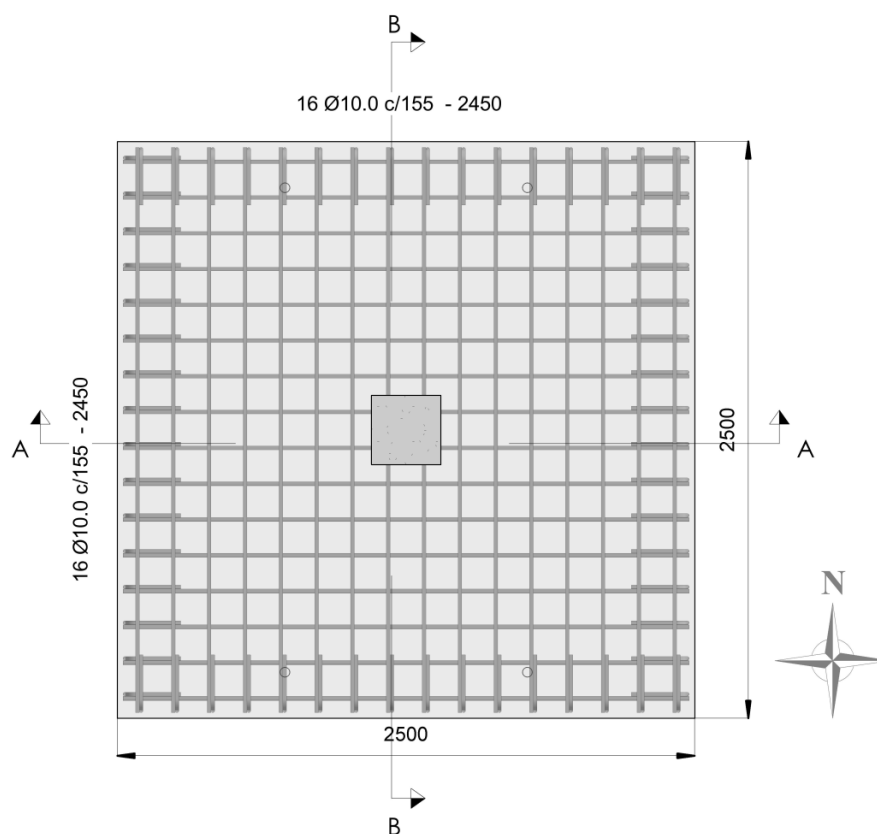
Detalhamento da armadura de flexão comprimida (medidas em milímetros)
